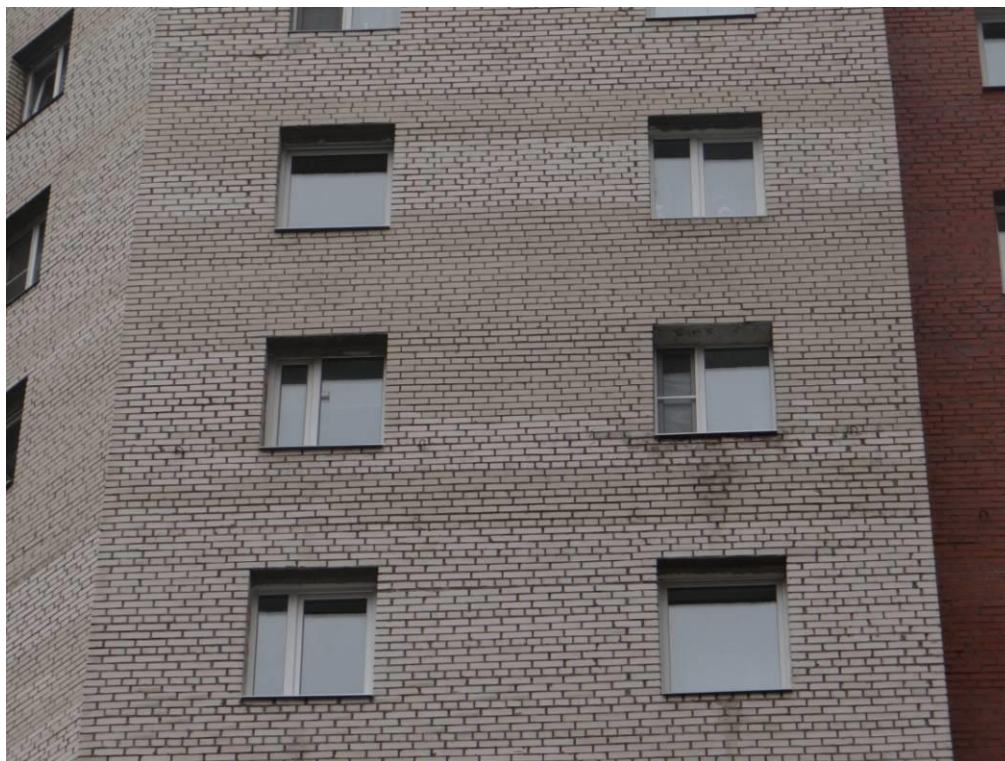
Фрагмент фасада по оси «Д» на участке в осях «б» - «4» в уровне 9 этажа. Следы увлажнения кирпичной кладки под оконным проемом. Морозное разрушение материалов кладки на увлажненных участках.
